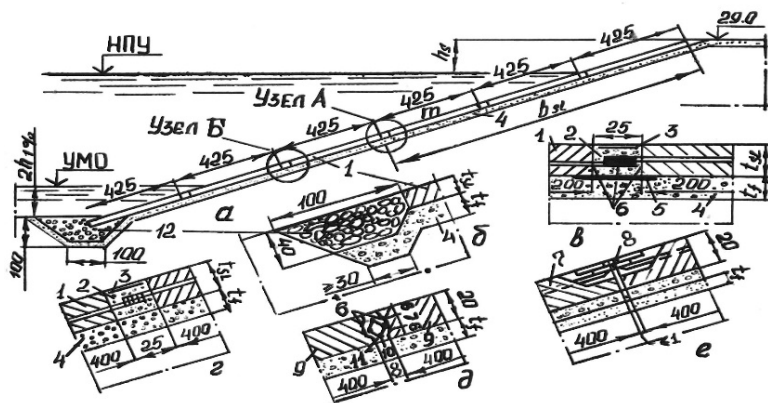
Конструкция крепления откоса сборными железобетонными плитами: *а* – разрез крепления; *б* – вариант упора крепления откоса без берма; *в* – поперечный температурно-осадочный шов (продольные швы – узел *А* – выполняют аналогично); *г* – омоноличенный стык жесткосоединенных плит (узел *Б*); *д* – омоноличенный стык шарнирно соединенных плит; *е* – шарнирное соединение плит с открытыми швами; 1 – плиты ПКП-II; 2 – бетон; 3 – сетка из стержней диаметром 8 мм через 0,2 м; 4 – фильтровая подготовка; 5 – битумный мат $t = 1$ см; 6 – окраска битумом в два слоя; 7, 9 – плиты ПКП-III и ПКП-IV; 8 – хомут диаметром 18 мм; 10 – арматура диаметром 6 мм; 11 – бетон с мелким заполнителем; 12 – упорная призма из камня размером 12–15 см (размеры в сантиметрах)
